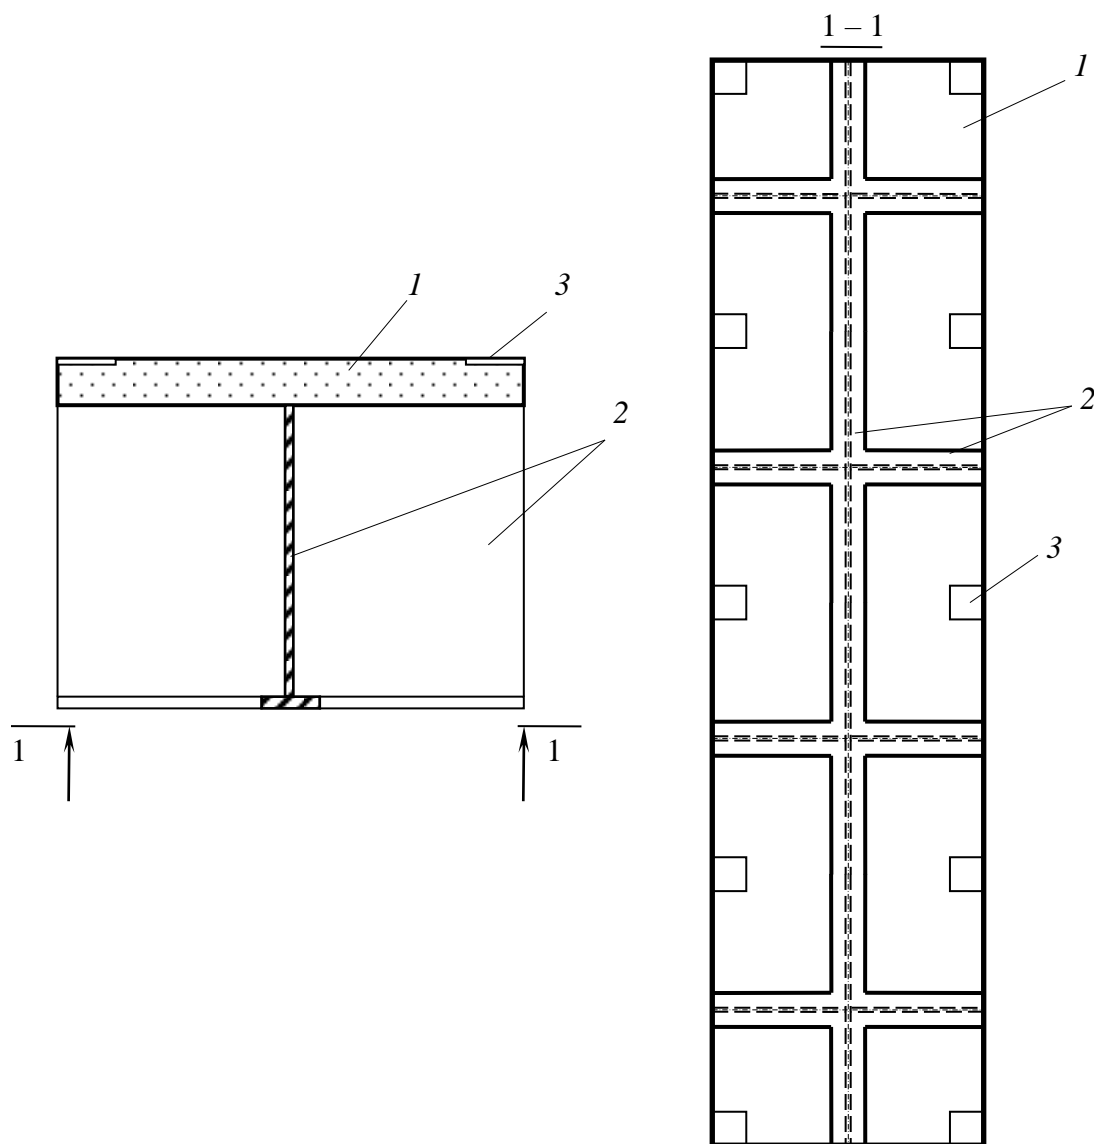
Лінійний елемент часторебристого сталезалізобетонного перекриття:
